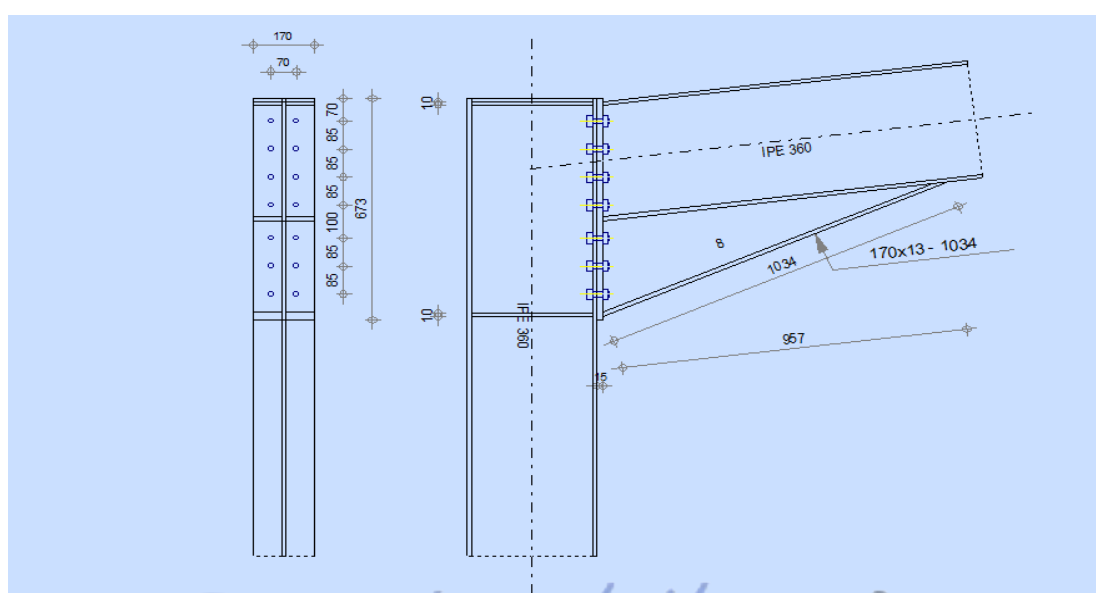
Détail d'assemblage poteau-traverse (IPE360-IPE360)
